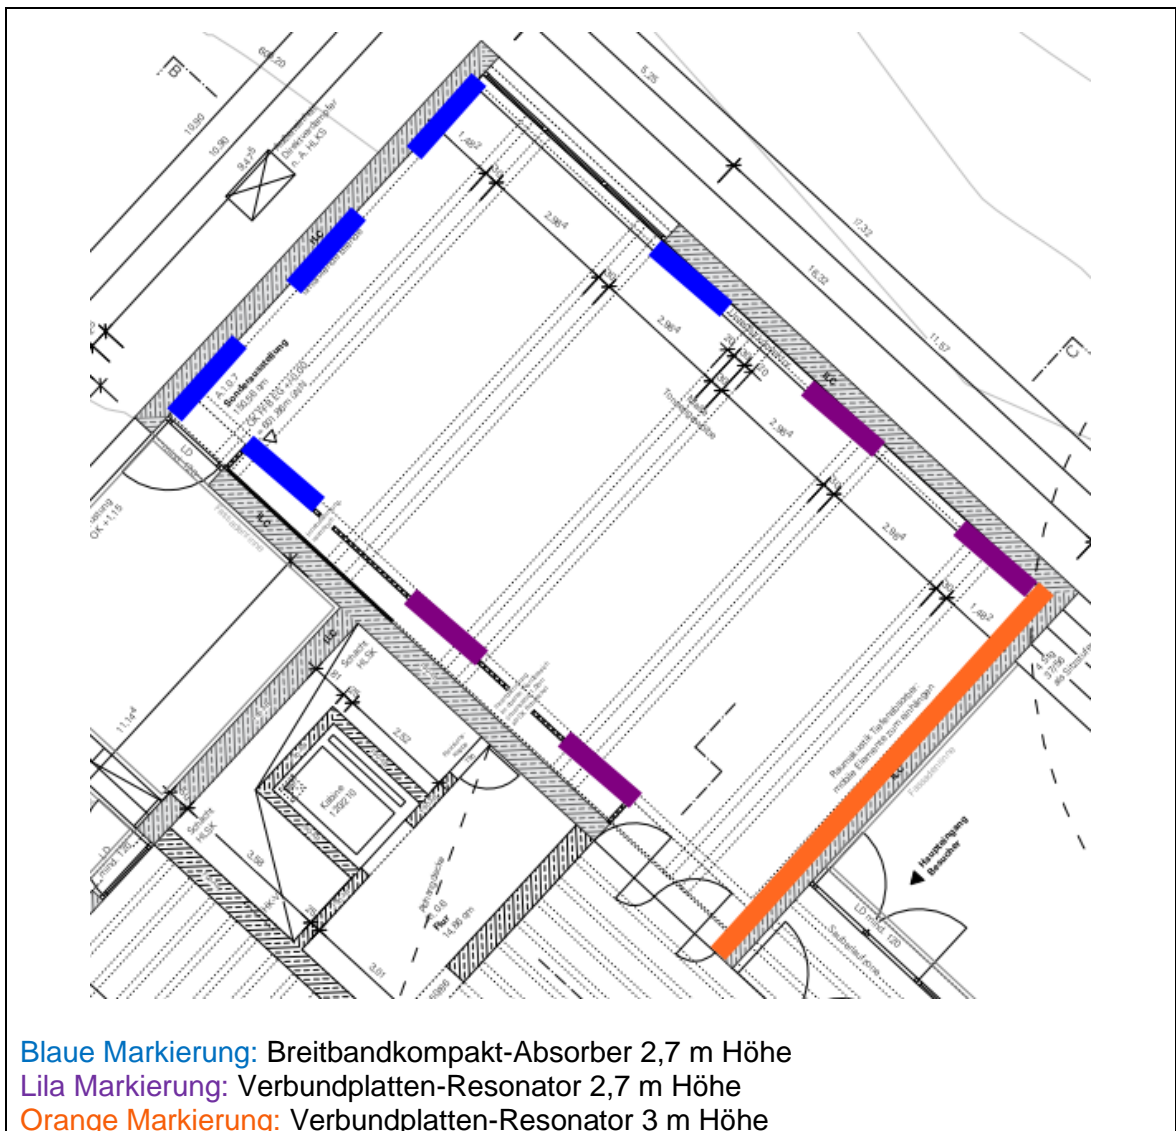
Anordnung Wandabsorber, Führung, eingetragen in Grundriss Meck Architekten [27]
